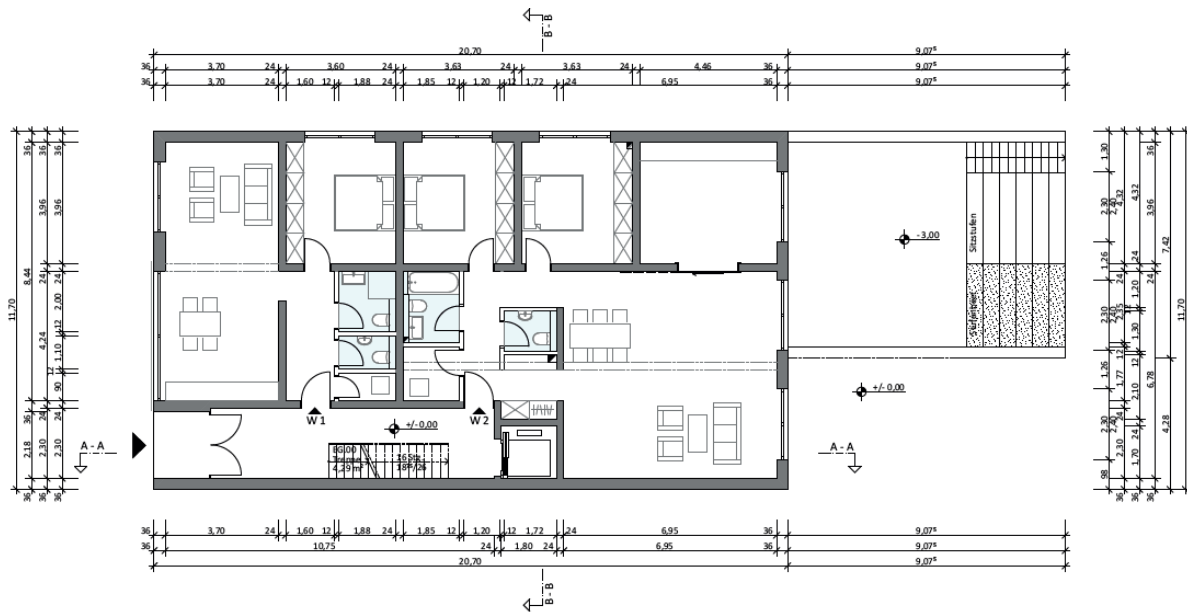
Der erste Fünfer – Grundriss Erdgeschoss (ohne Maßstab)
